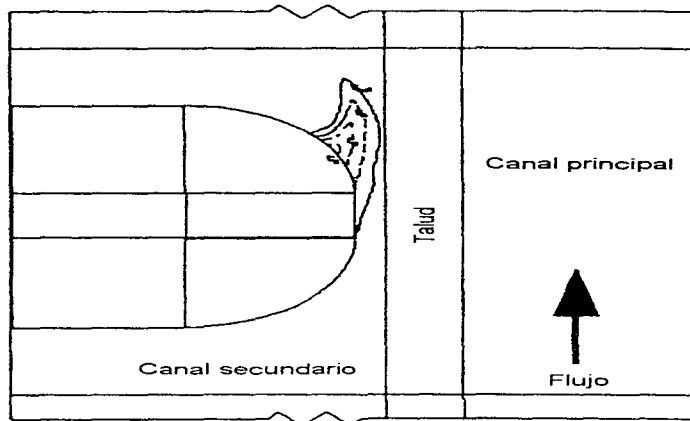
Vista en planta de la localización de inicio de falla en pedraplenes para estribos derramantes, según Atayee.⁽⁸¹⁾
